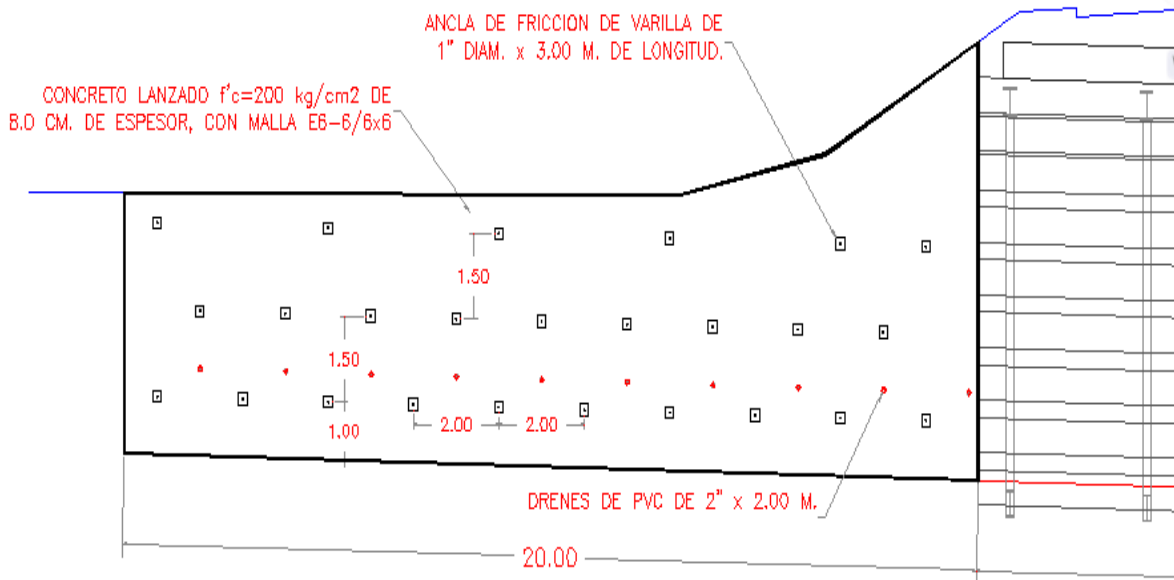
Detalle de lateral izquierdo portal Tenango
